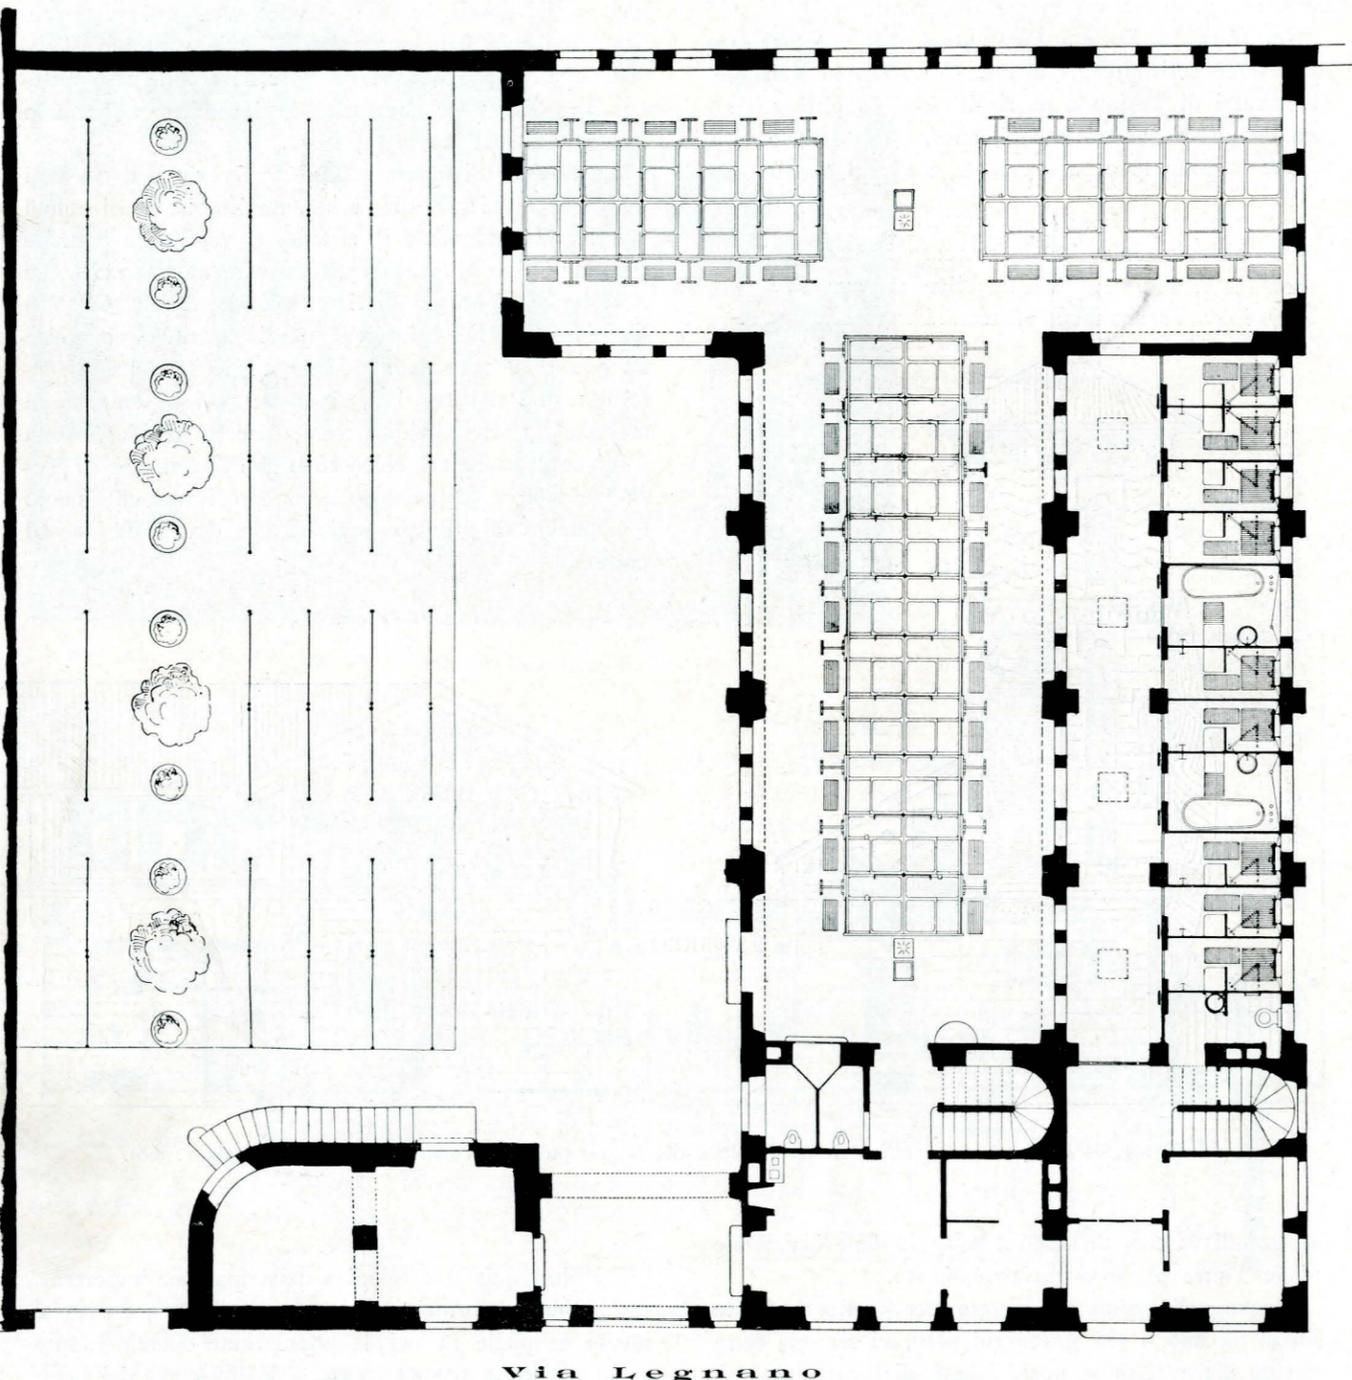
Pianta del piano terreno del Lavatoio e del Bagno popolare di Borgo San Secondo (Scala 1:300).
